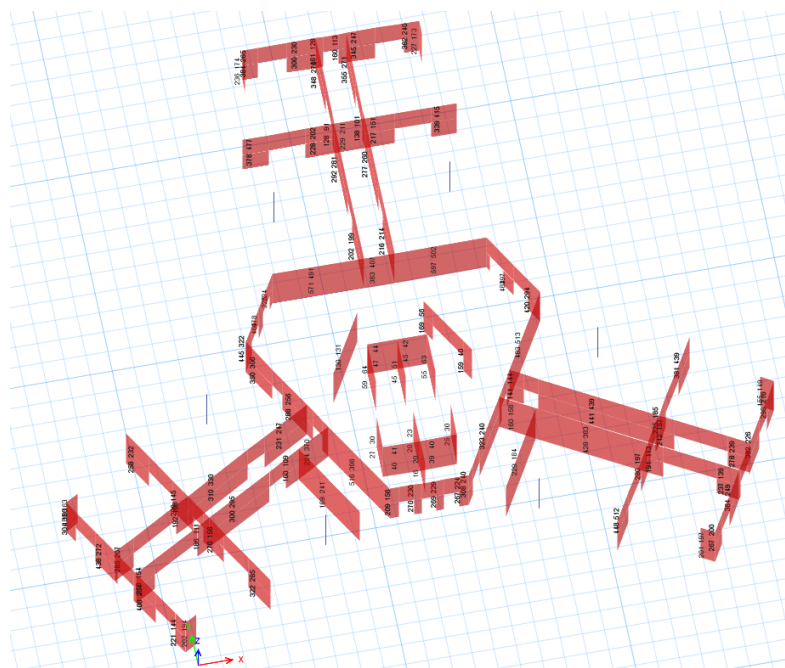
Фрагмент армирования стены (ДЖМ) на отм. 0.000 м до отм. 4.95 м (площадь полной арматуры)
